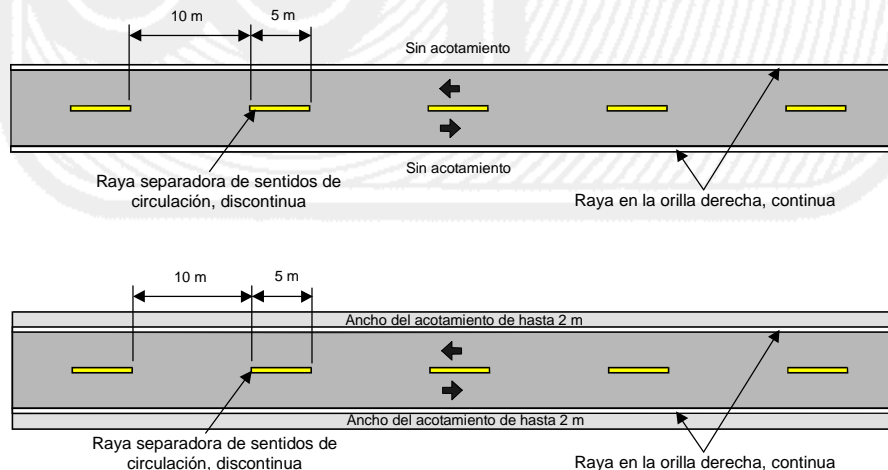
Marcas en el pavimento en carreteras con ancho de calzada de hasta 6,5 m
